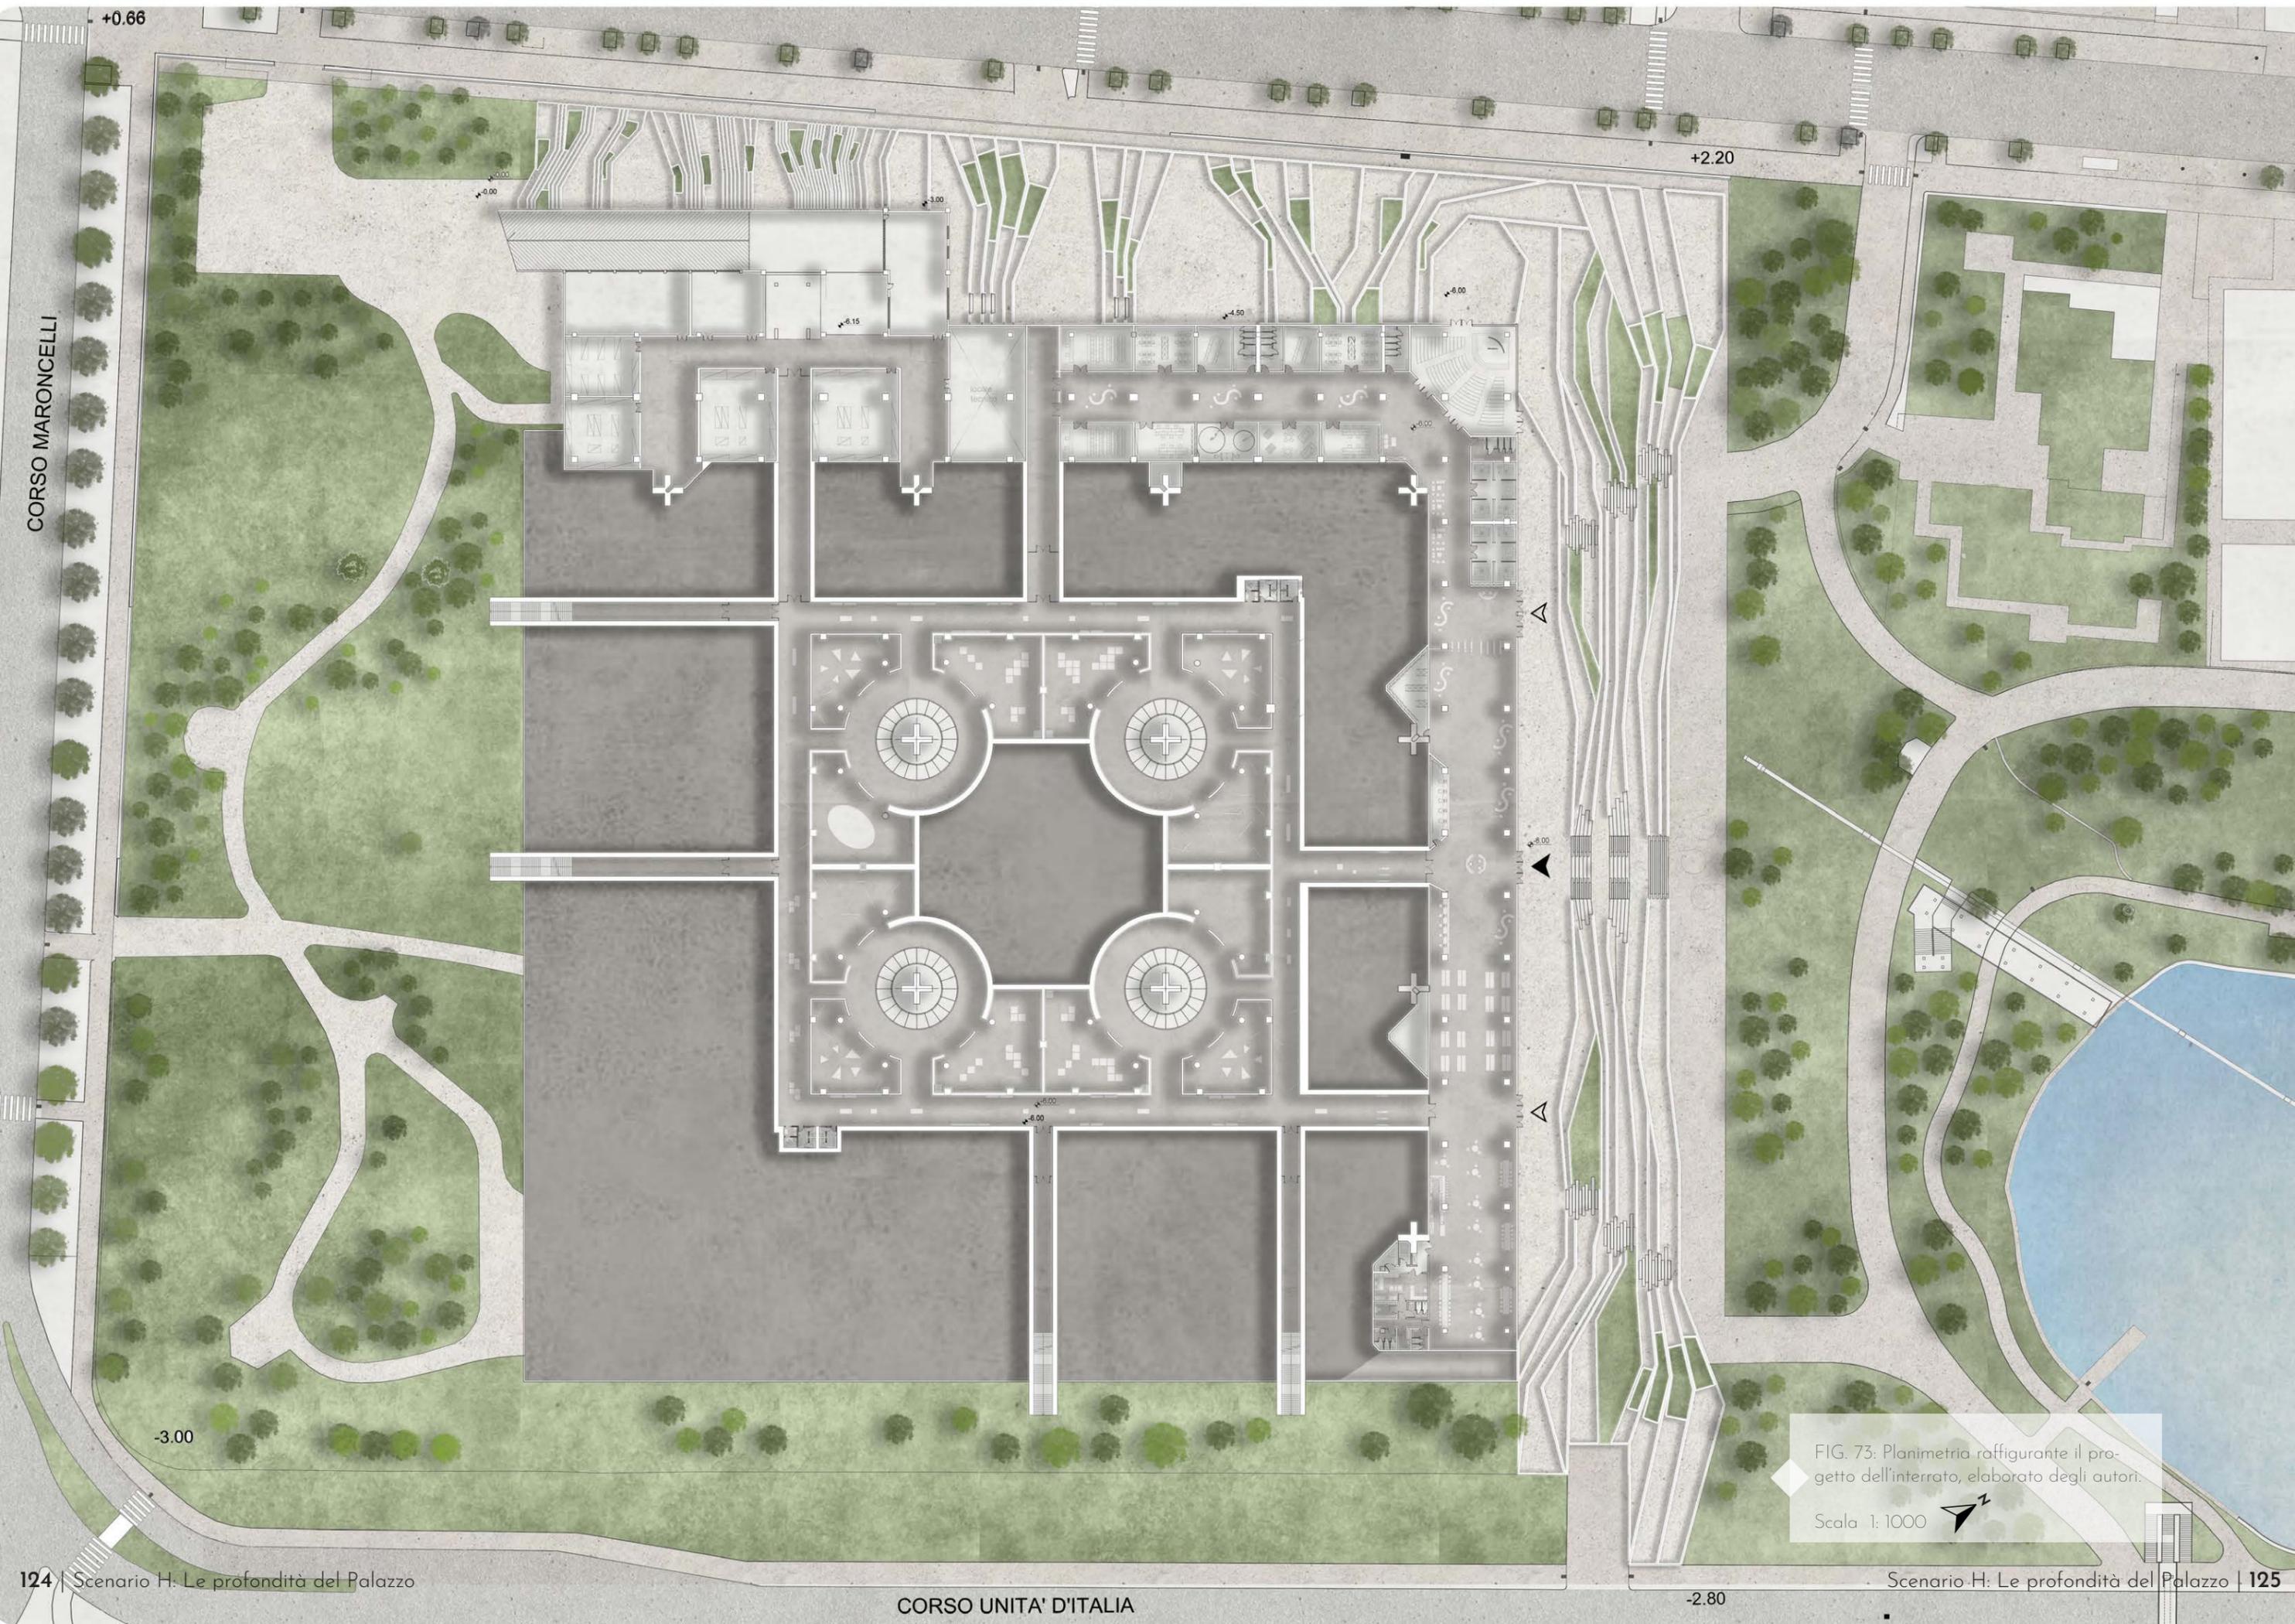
Planimetria raffigurante il progetto dell'interrato, elaborato degli autori.
